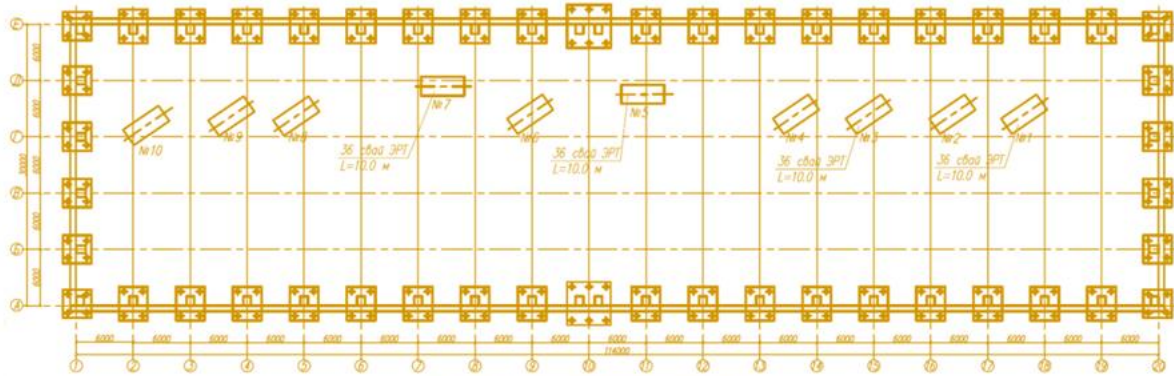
План свайного поля из буроинъекционных свай ЭРТ
